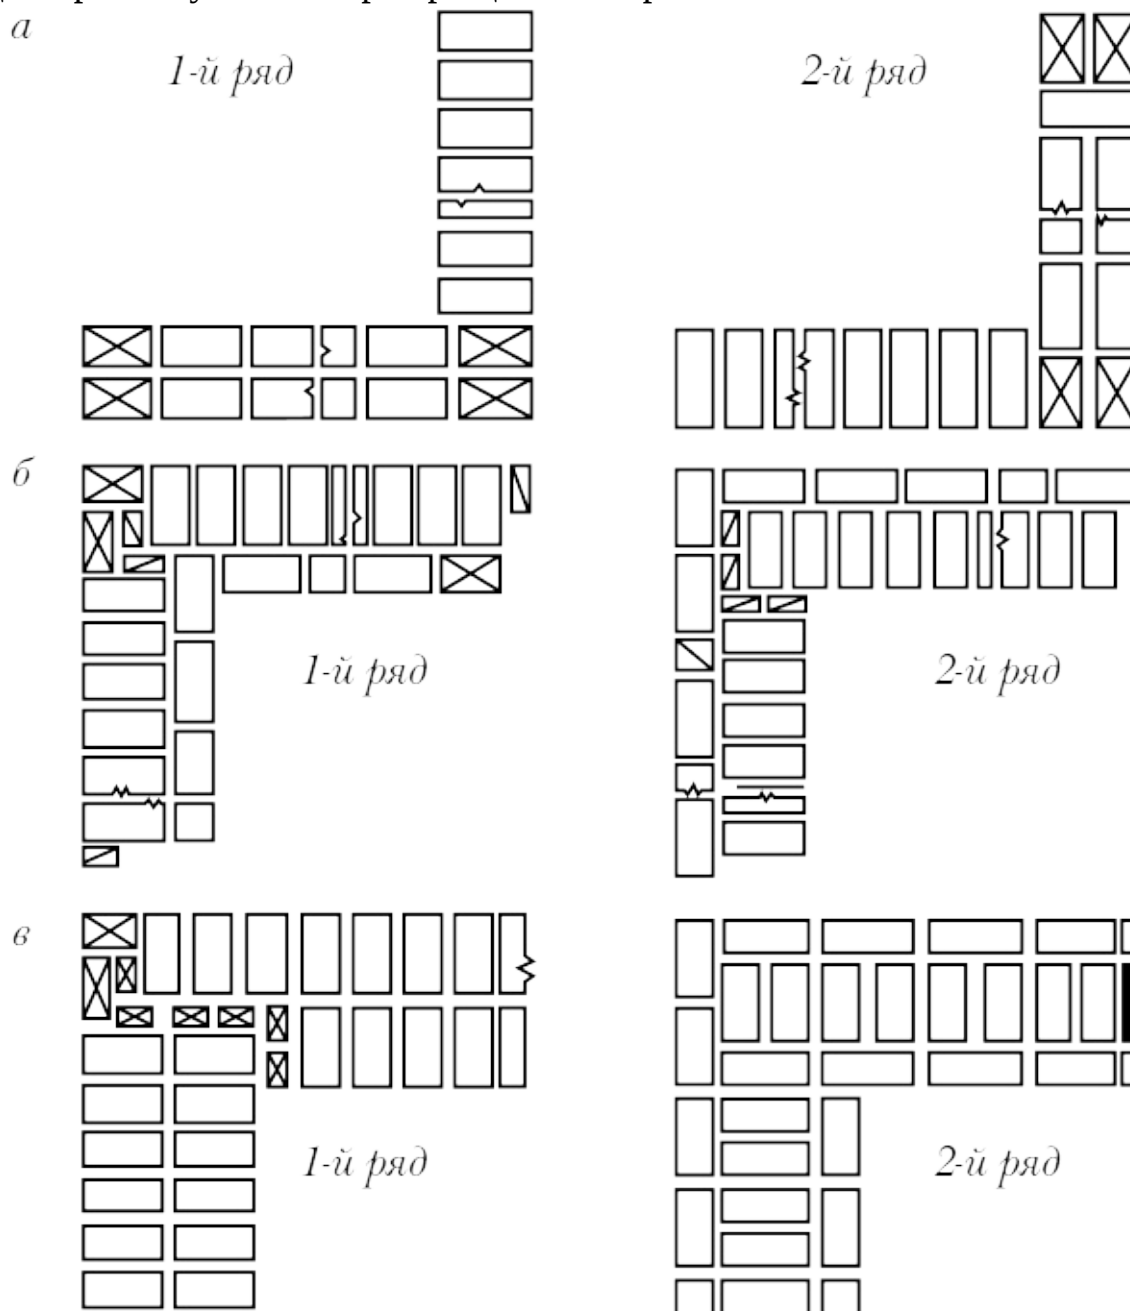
Кладка прямых углов: а) стена толщиной в 1 кирпич, б) стена толщиной 1,5 кирпича, в) стена толщиной 2 кирпича Расшивка швов
